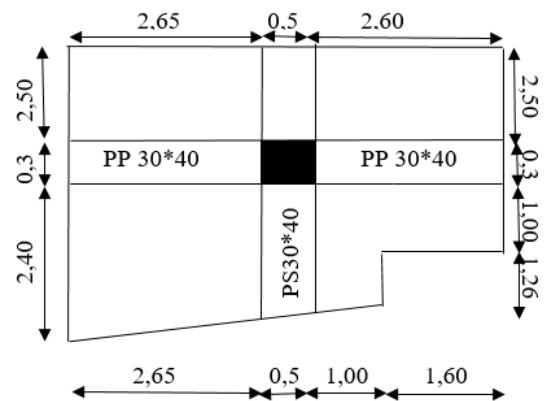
Emplacement de Poteau terrasse Inaccessible
